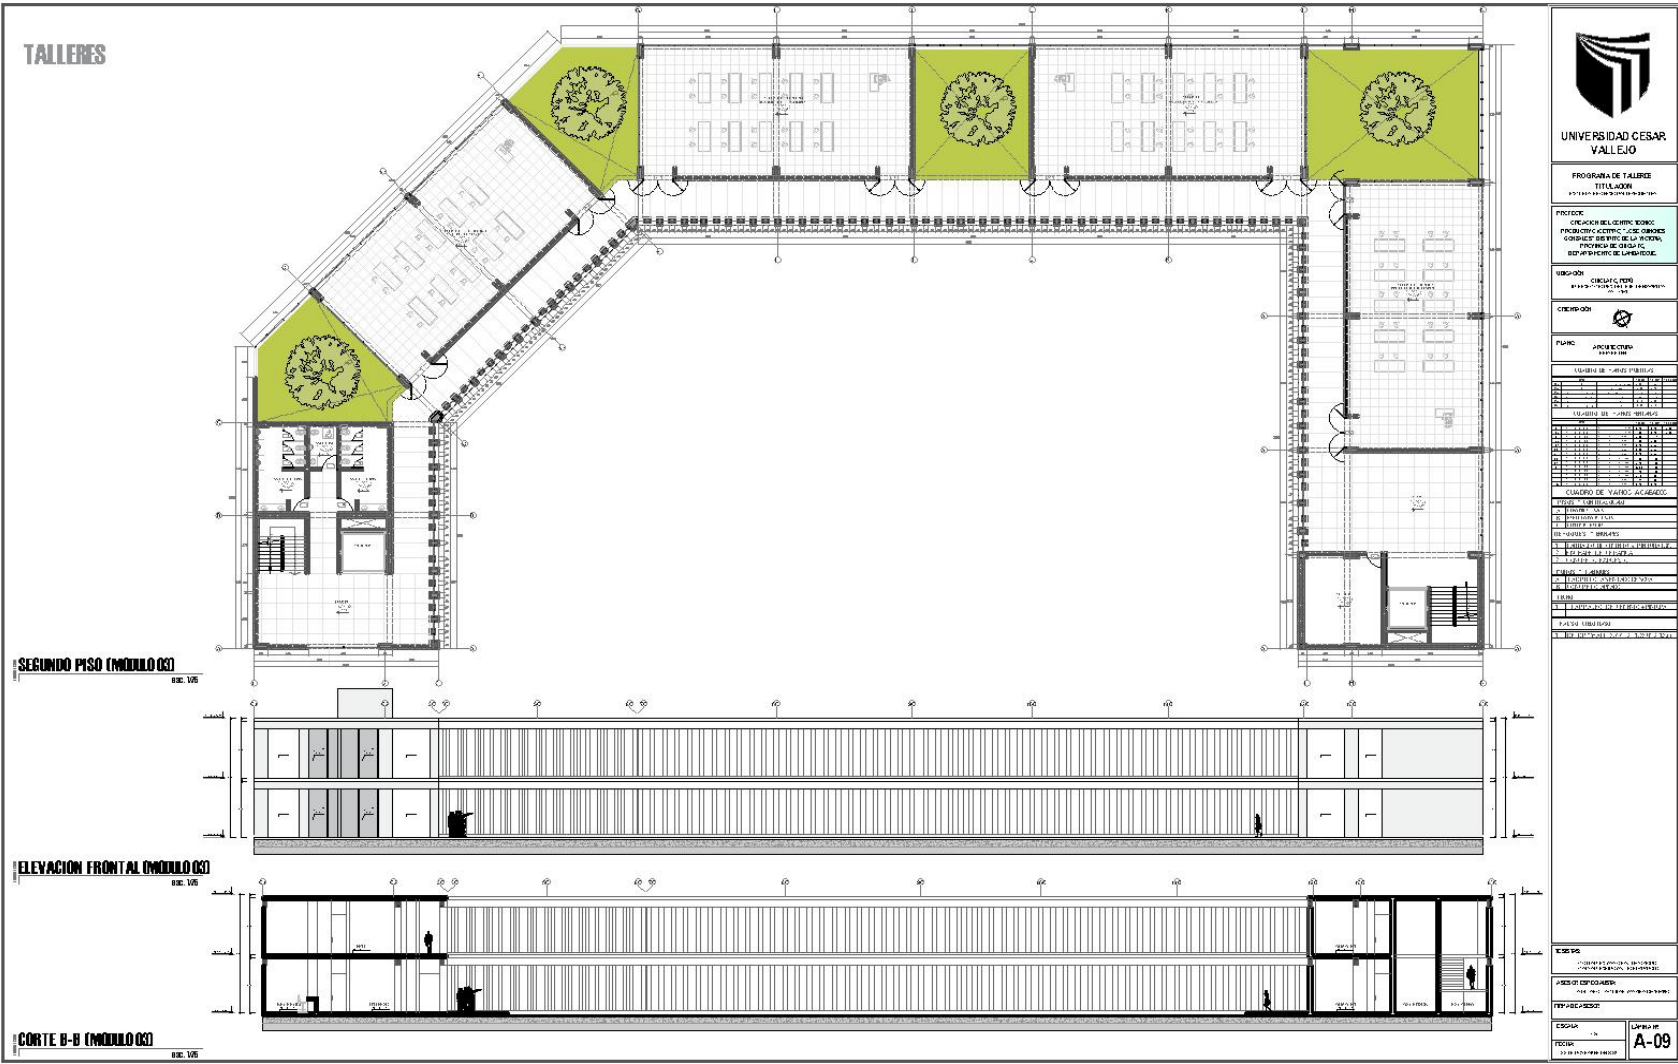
Plano modulo 03 primer nivel, cortes y elevaciones.
